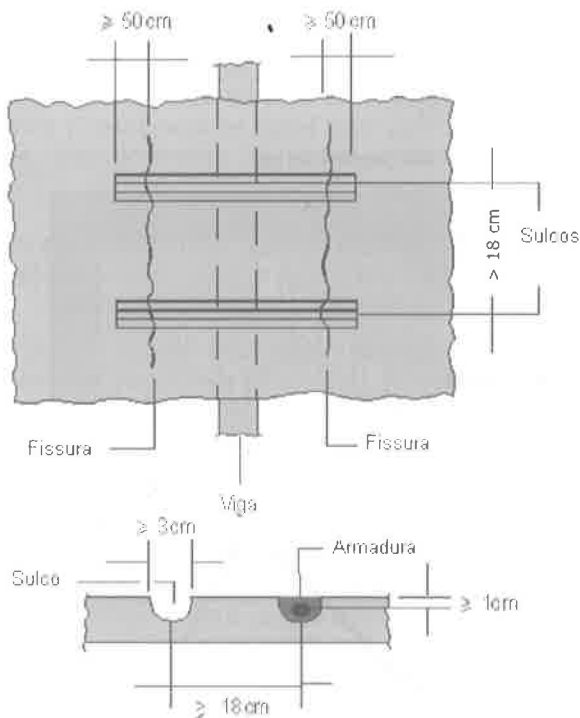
Reforço de flexão em lajes com argamassa epóxi e armadura positiva.
